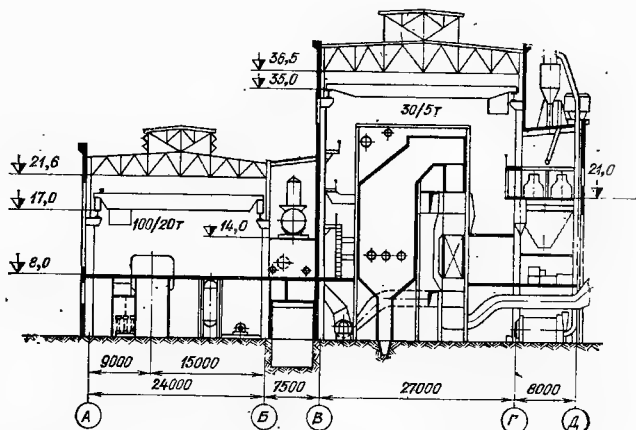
Компоновка главного корпуса с наружной бункерной этажеркой (поперечный разрез)
